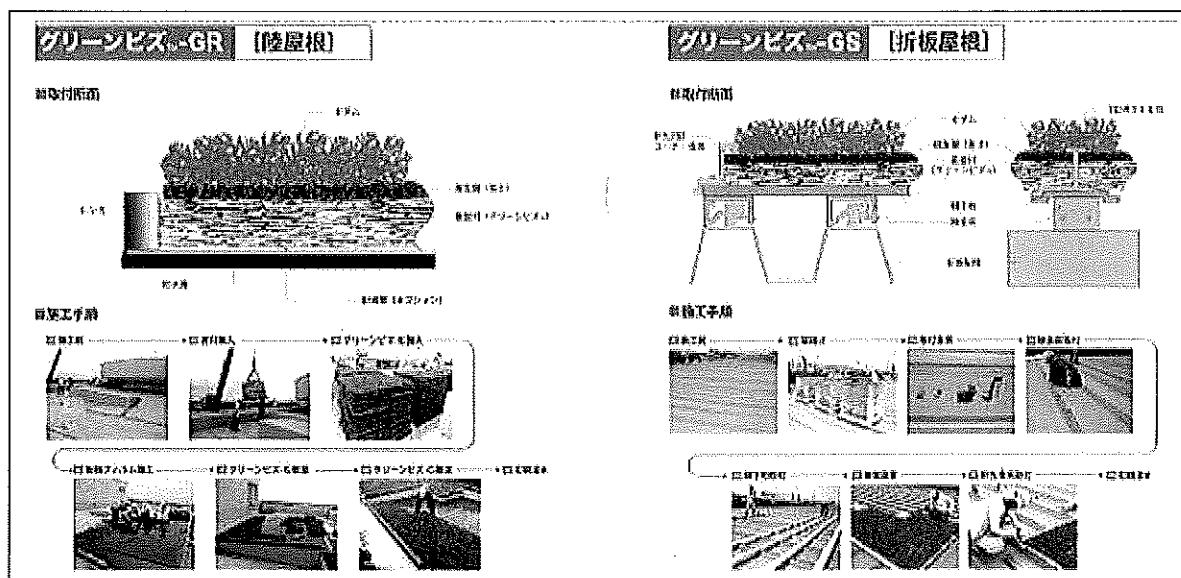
グリーンビズ-G 陸屋根・折板屋根の施工方法
